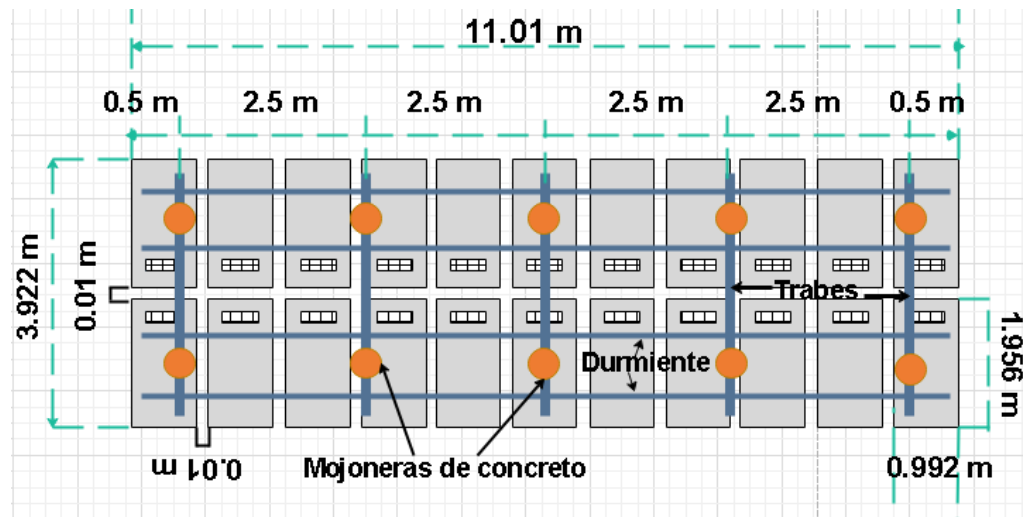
Vista de Planta de la UBM (Fuente elaboración propia)
